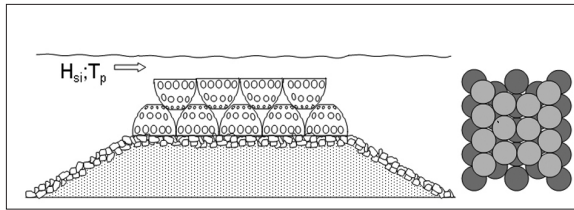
B-F2* sezione (sx) ed in pianta (dx).
